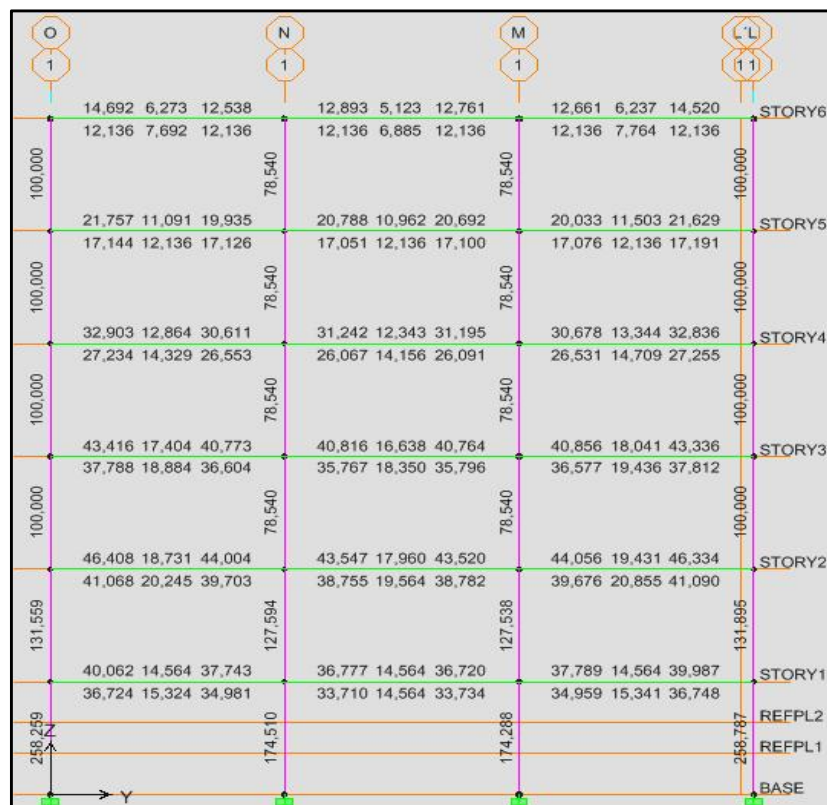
Acero en vigas pórtico 1, Gobernantes
